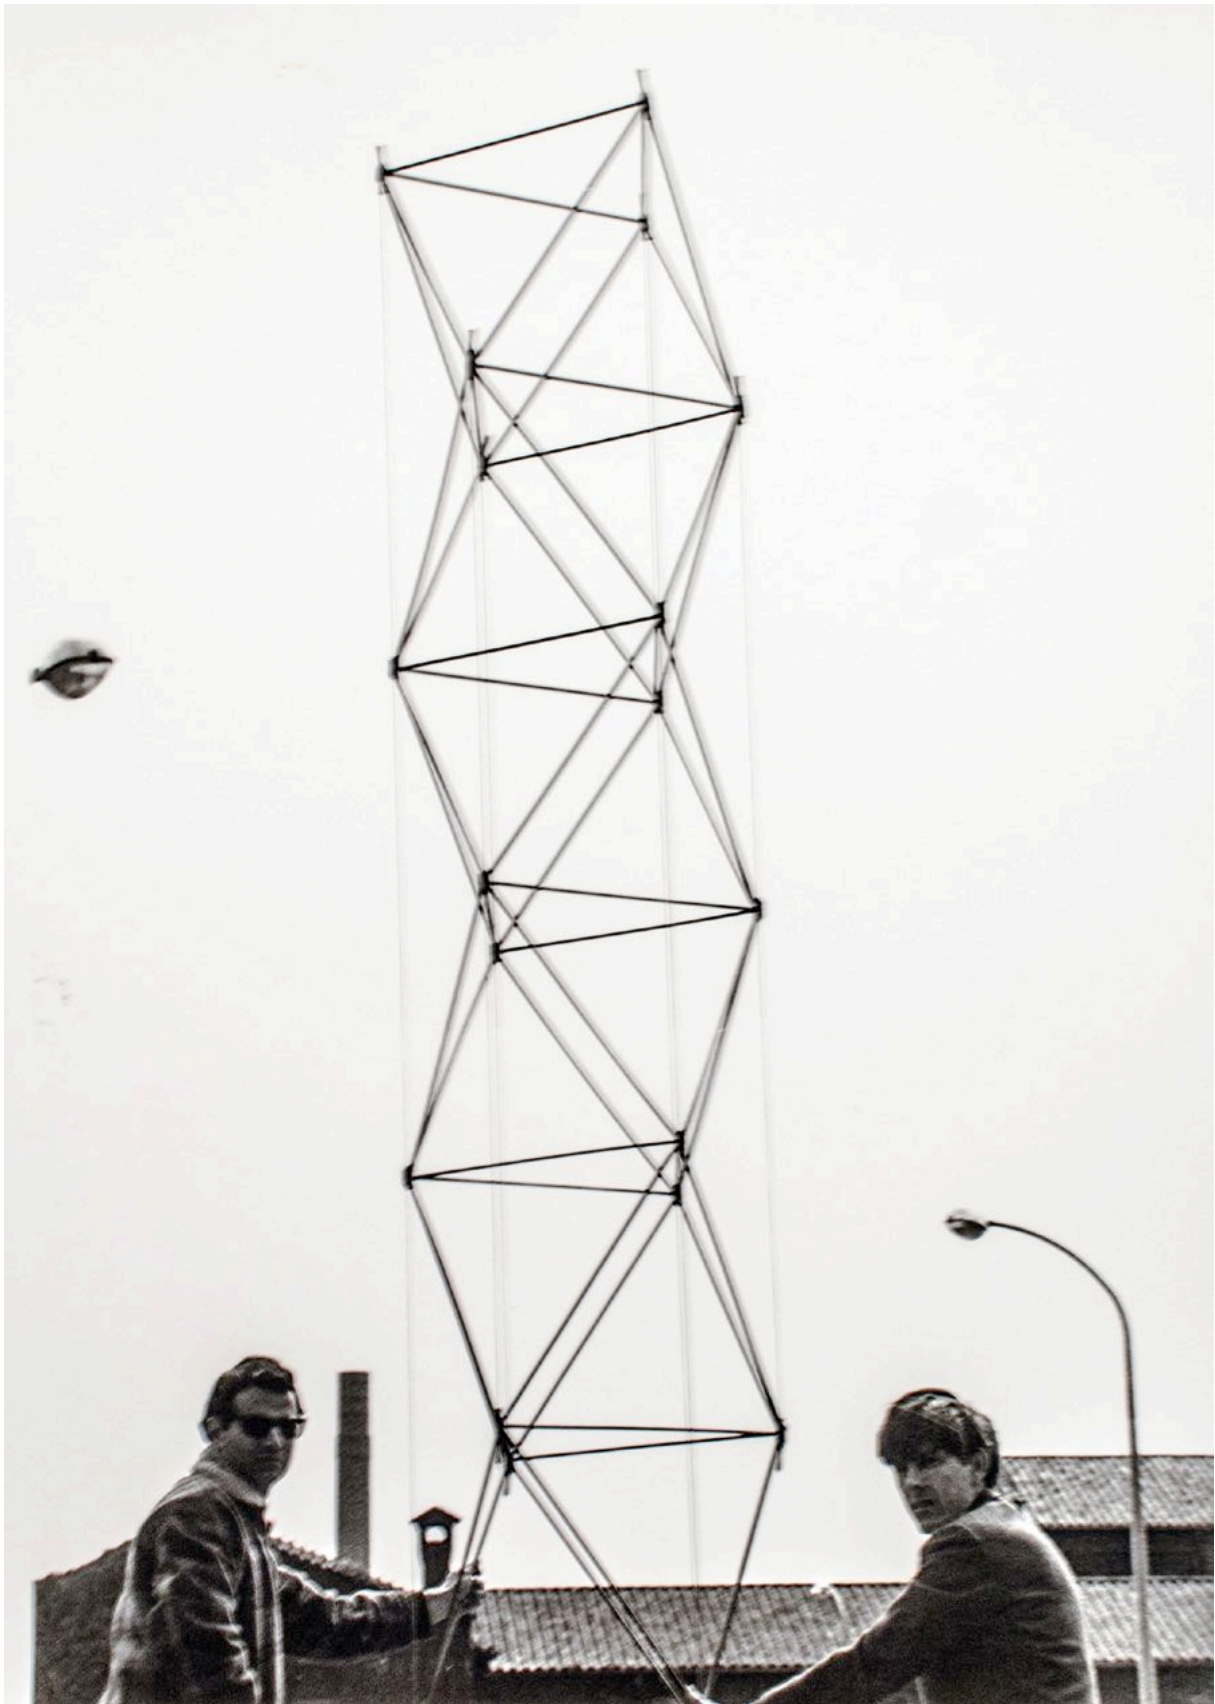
Robert Le Ricolais, sistema strutturale Octen applicato alla costruzione di un'antenna, 1966. (AAUP)
